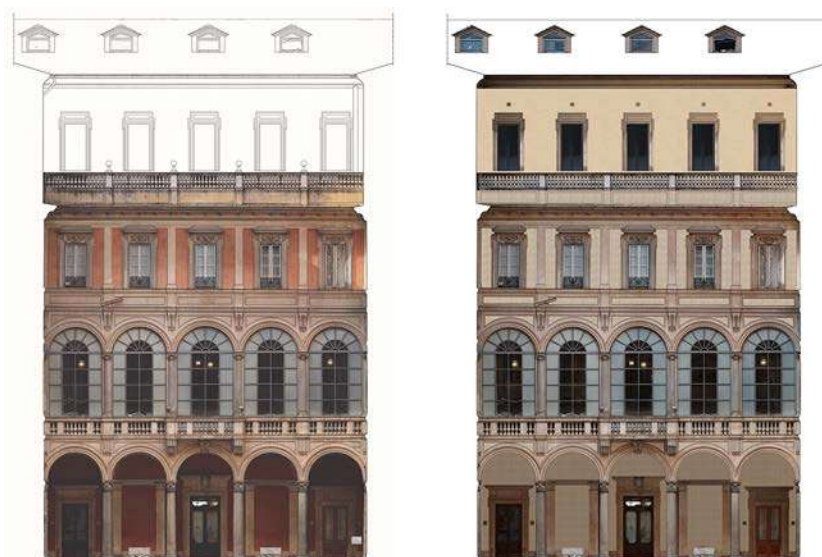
Prospetto ovest, stato di fatto e ipotesi progettuale (elaborazioni grafiche dell'autore).
